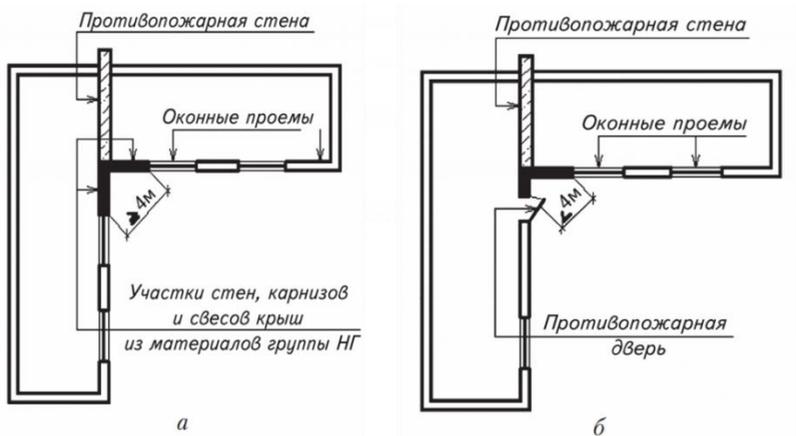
Схема расположения противопожарных стен при примыкании зданий (отсеков) под углом: а – расположение оконных проемов; б – расположение оконных и дверных проемов крыш, примыкающие к противопожарной стене под углом, должны быть выполнены из материалов группы НГ на длине не менее 4 м
